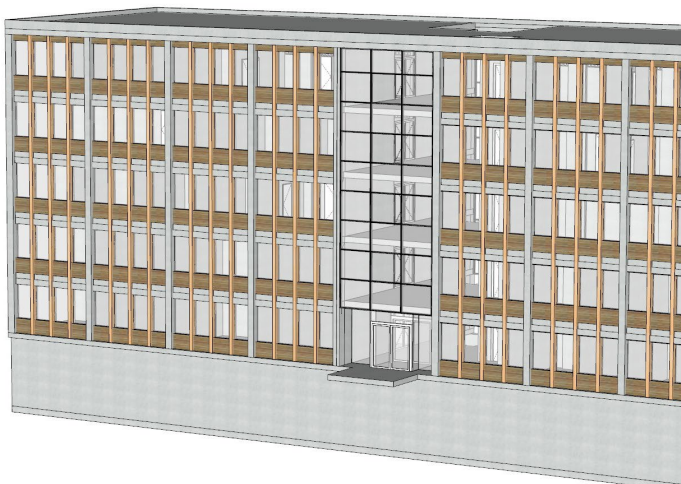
Einsetzen der neuen Fassadenelemente aus Holz
